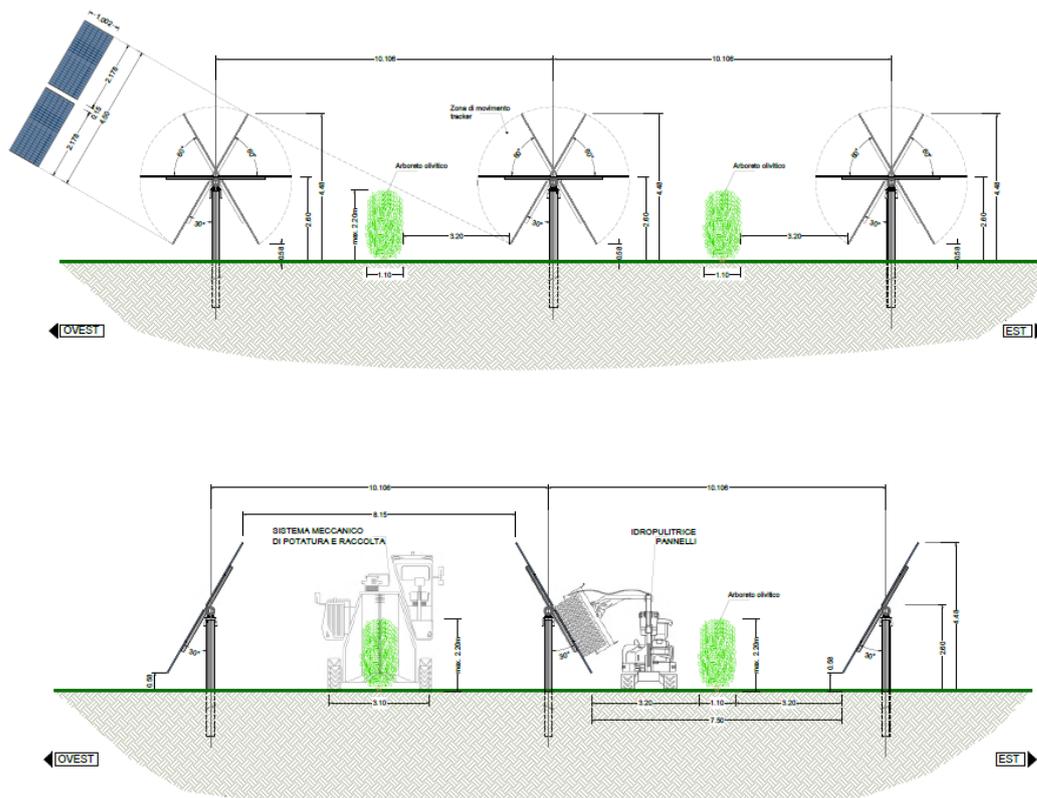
Sezione tipo del progetto agrivoltaico con alternanza pannelli fotovoltaici/coltivazione
